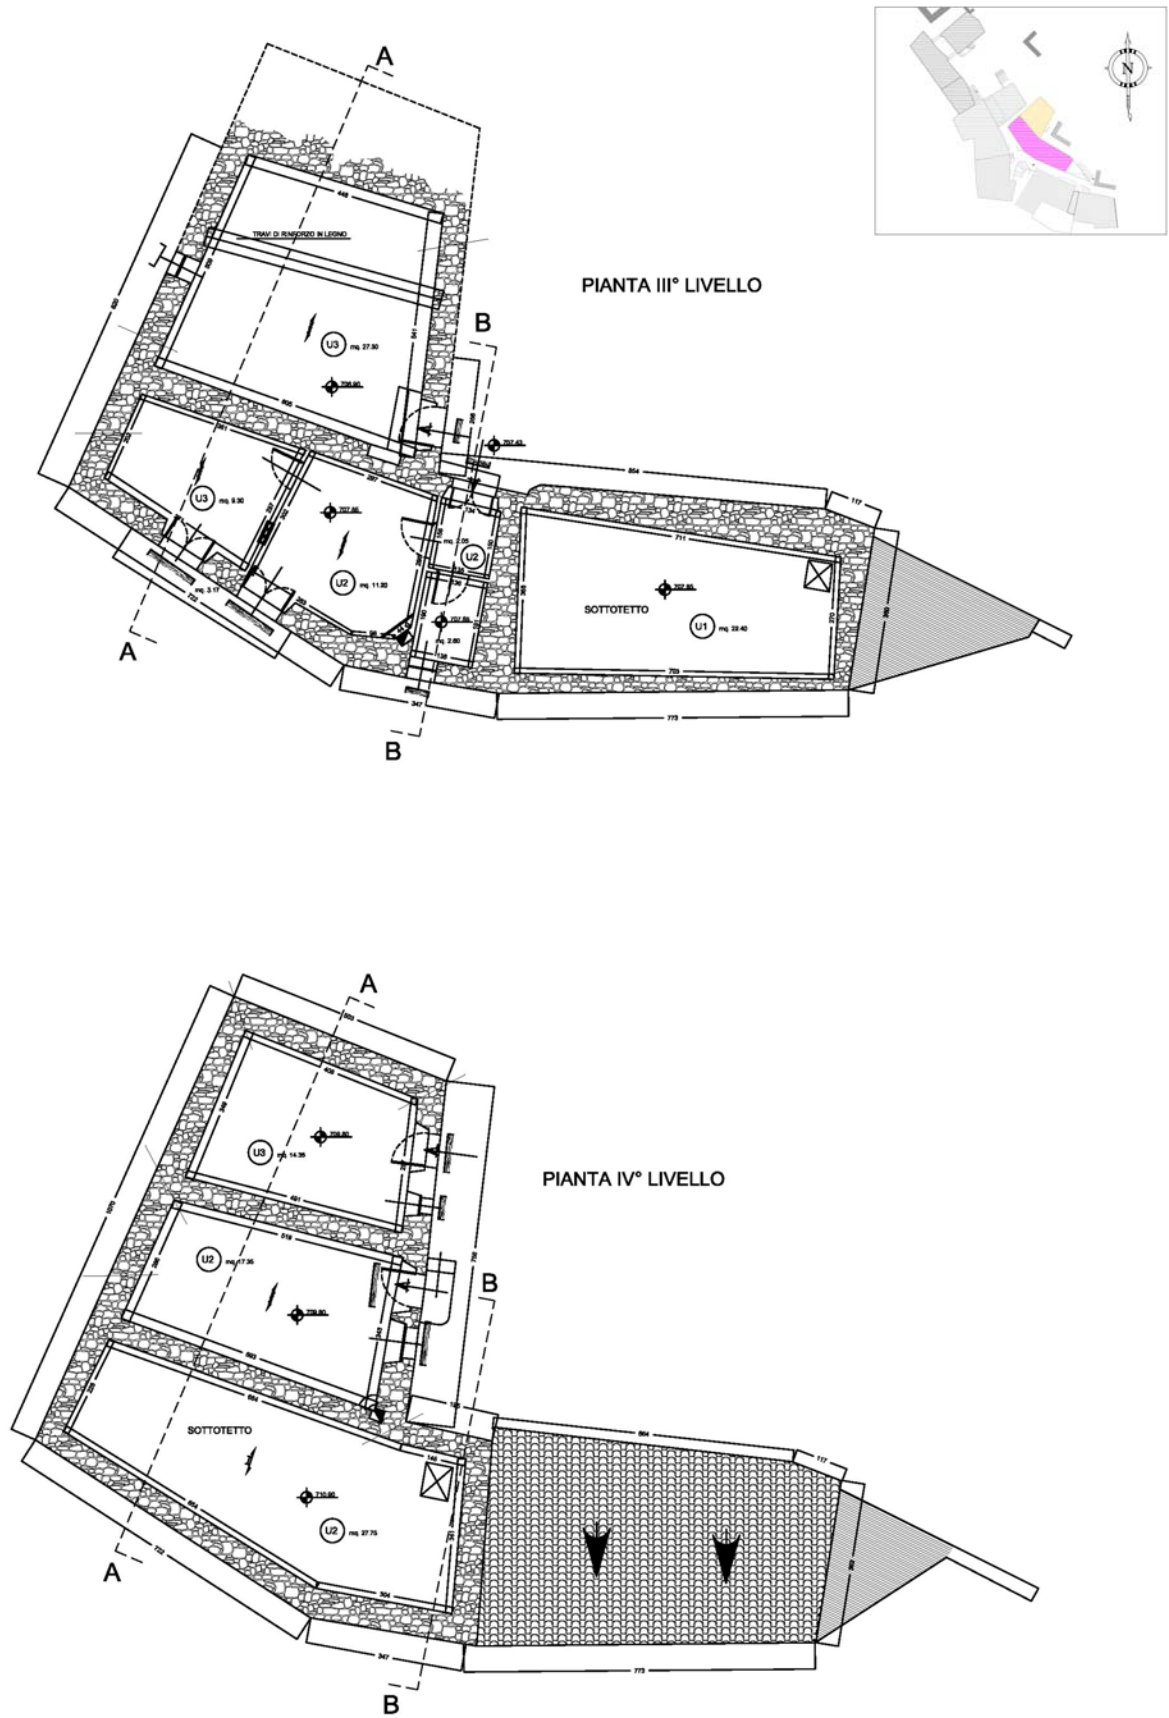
Planimetrie comparti 7/8. Stato di fatto
